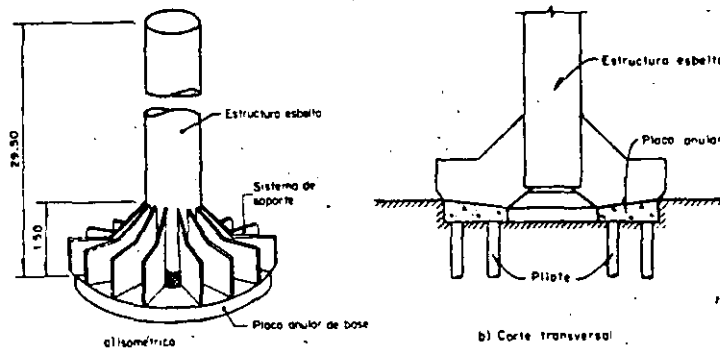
Cimentación sobre pilotes de fricción en planta circular y su conexión con una estructura esbelta
